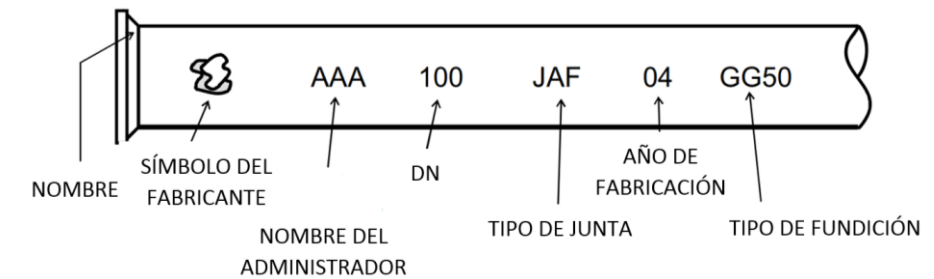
Detalle del marcado de las tuberías de fundición. (Adaptado de ITOHG-MAT-1/3)
